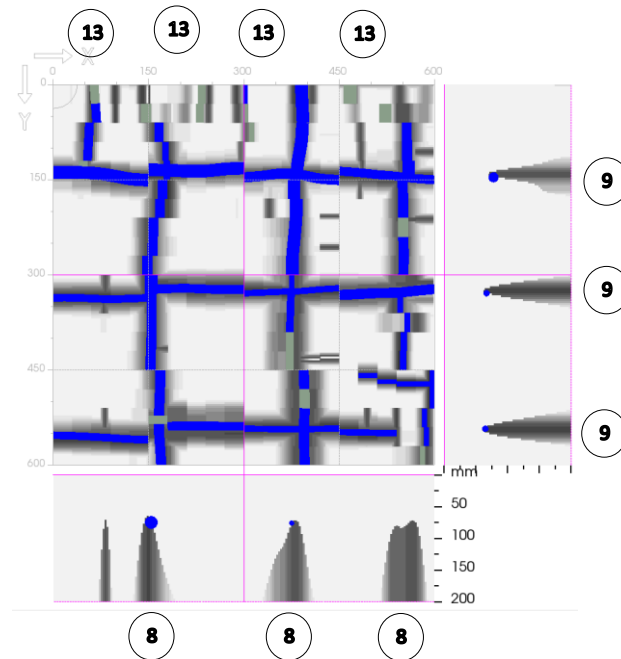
Ferrailage reconnu – Poutre Pt05
